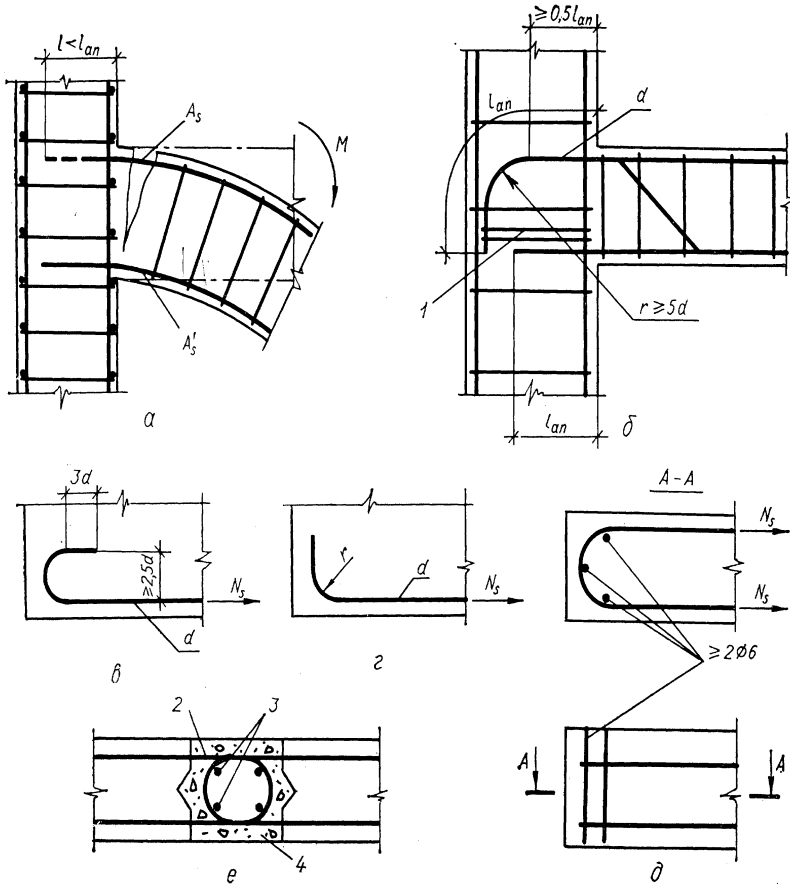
Анкерування розтягнутої арматури без попереднього напруження: *a* – висмикування арматури біля крайньої опори при недостатній довжині анкерування; *б* – забезпечення анкерування відгином стержнів; *в* – гаками на кінцях гладких стержнів; *г* – лапками на кінцях стержнів періодичного профілю; *д* – поперечне армування у збірних конструкціях; *е* – те саме, у збірно-монолітних конструкціях; 1 – додаткові хомути, що перешкоджають розгинанню стержнів; 2 – анкерований стержень; 3 – поперечна арматура не менш як $2\phi_6$; 4 – бетон замонолічування
